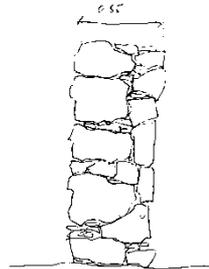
Paredes de alvenaria de pedra com junta seca.
